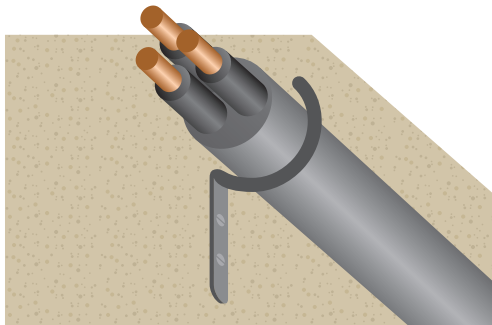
Conducteurs isolés dans un conduit en montage apparent
